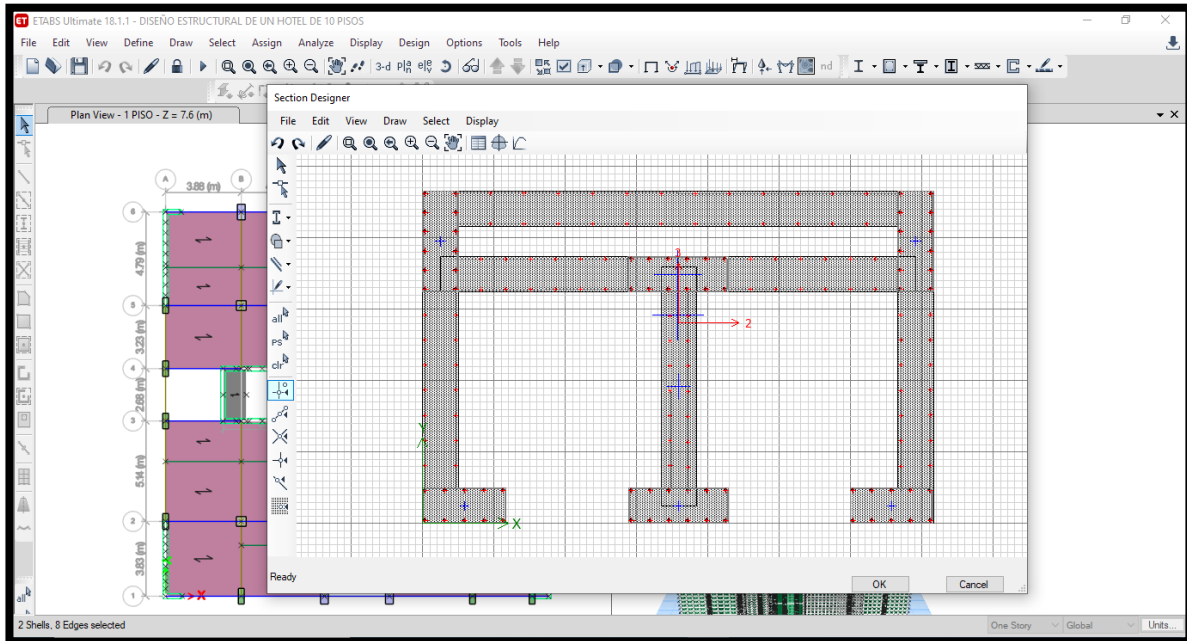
Vista en planta del armado de acero en la sección del ascensor: PL - 2.
